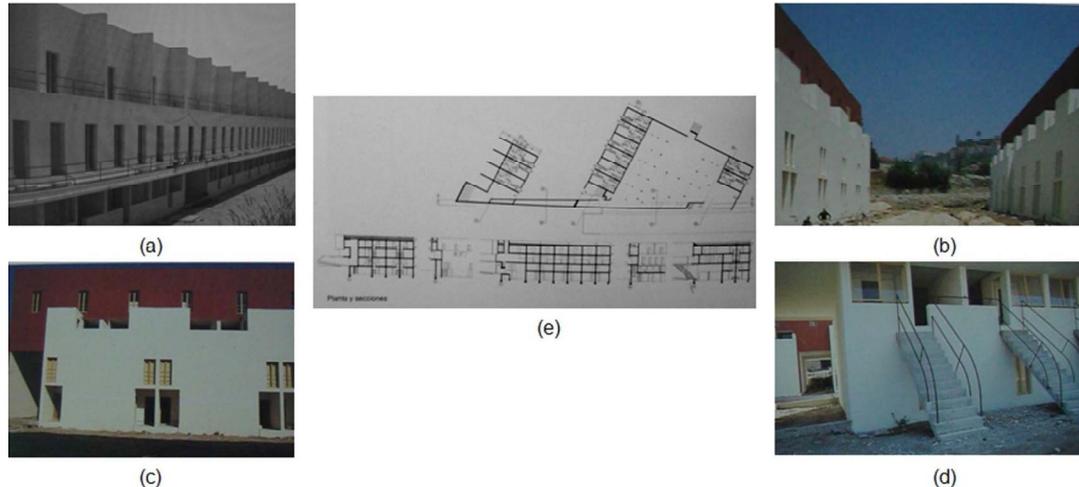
Alvaro Siza, Barrio de Bouça, Oporto, Portugal, (1973-1978): (a) Vista de la fachada posterior, (b) Vistas de las fachadas, (c) y (d) Fragmentos de la fachada, (e) Planta y secciones.
